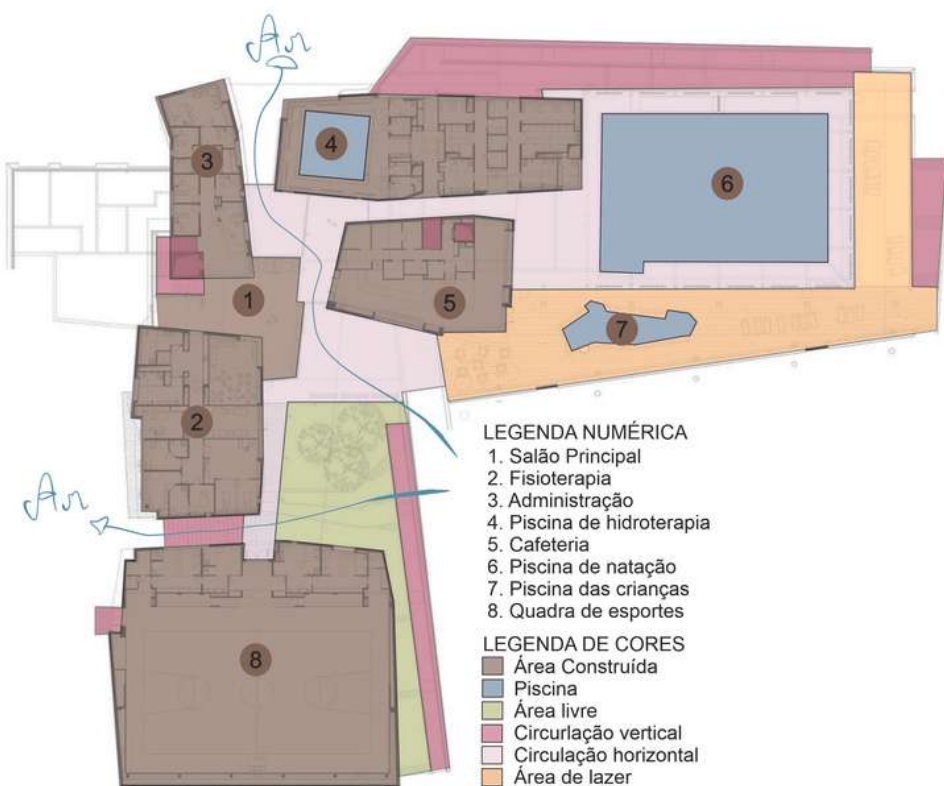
Planta térrea. Beit-halochem Rehabilitation Center Kimmel. Fonte: Archdaily, analisado pela autora.
